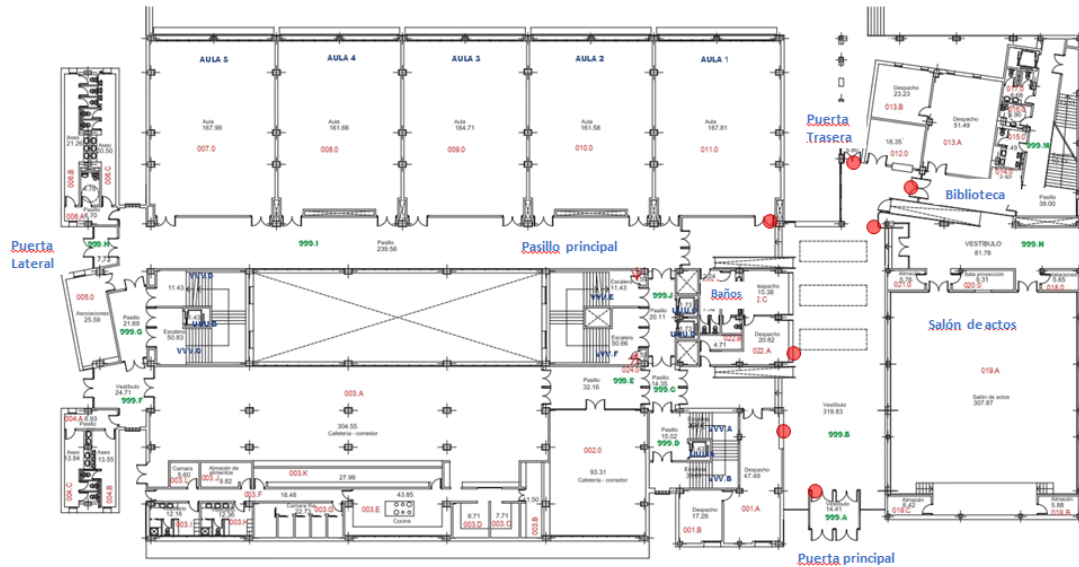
Mapa de la planta baja de la Facultad de Informática con la ubicación definitiva de los beacons (rojo) en el hall.
